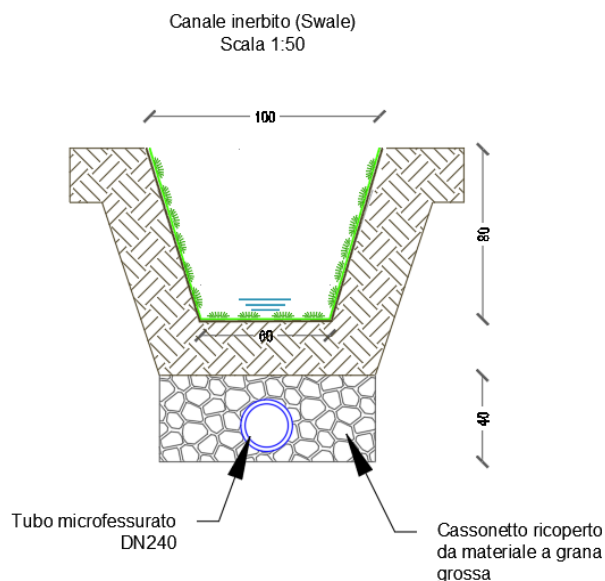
Rappresentazione schematica degli swales con cassonetto
